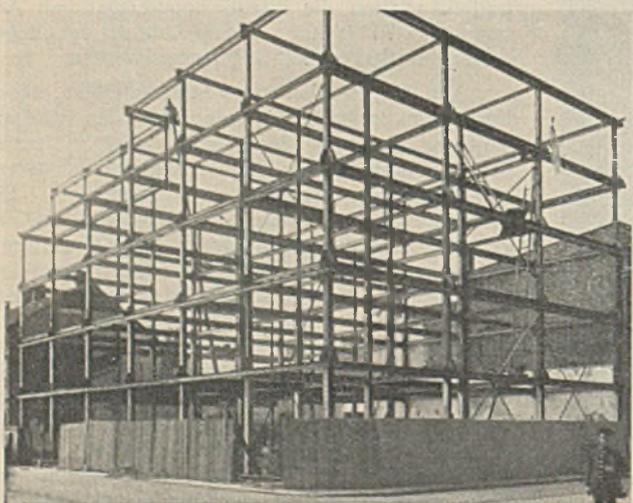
Stahlskelett des Möbelhauses Gladtko, Oberhausen.
